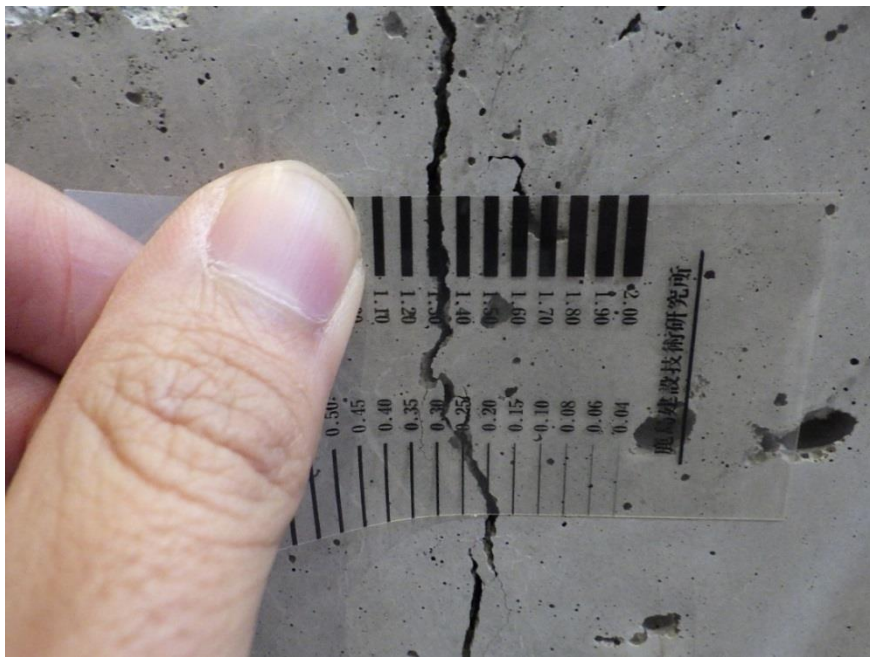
試験体①のひび割れ発生状況 (3/3)
